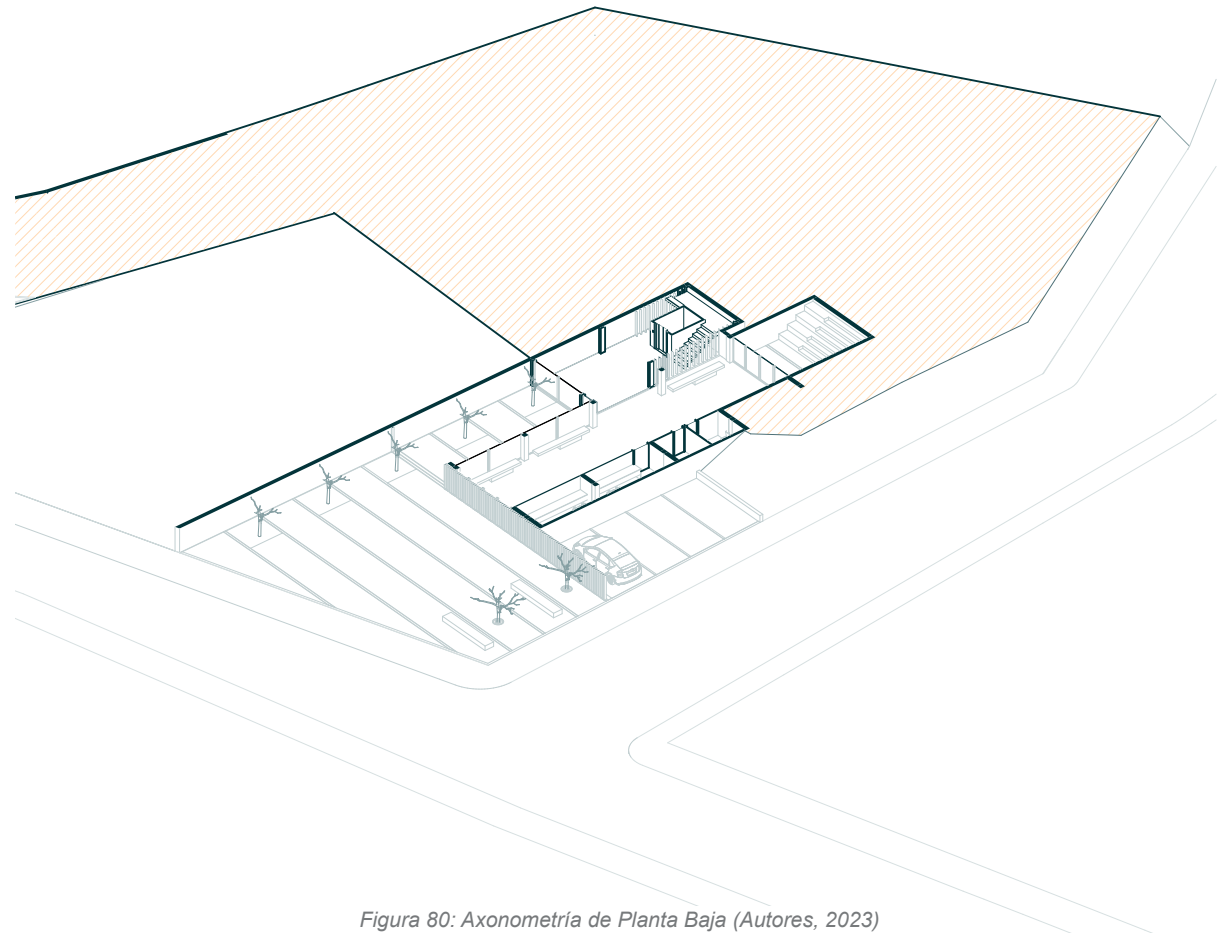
Axonometría de Planta Baja (Autores, 2023)
